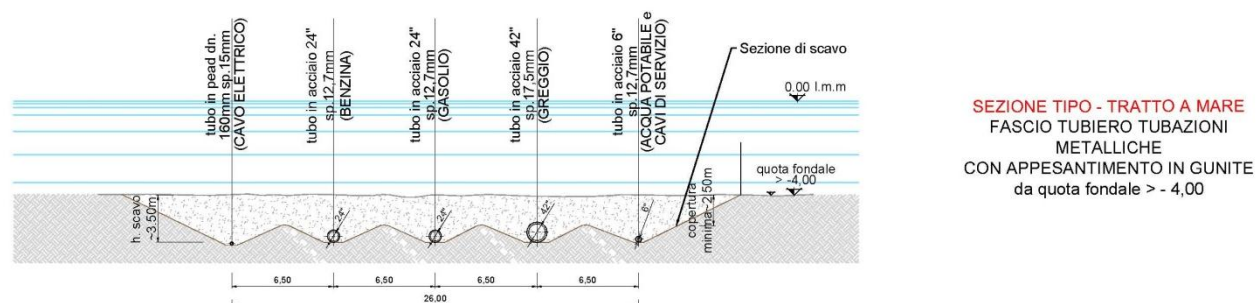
Fascio tubiero - tratto a mare : sezione di posa da quota fondale > - 4.00 m slmm
